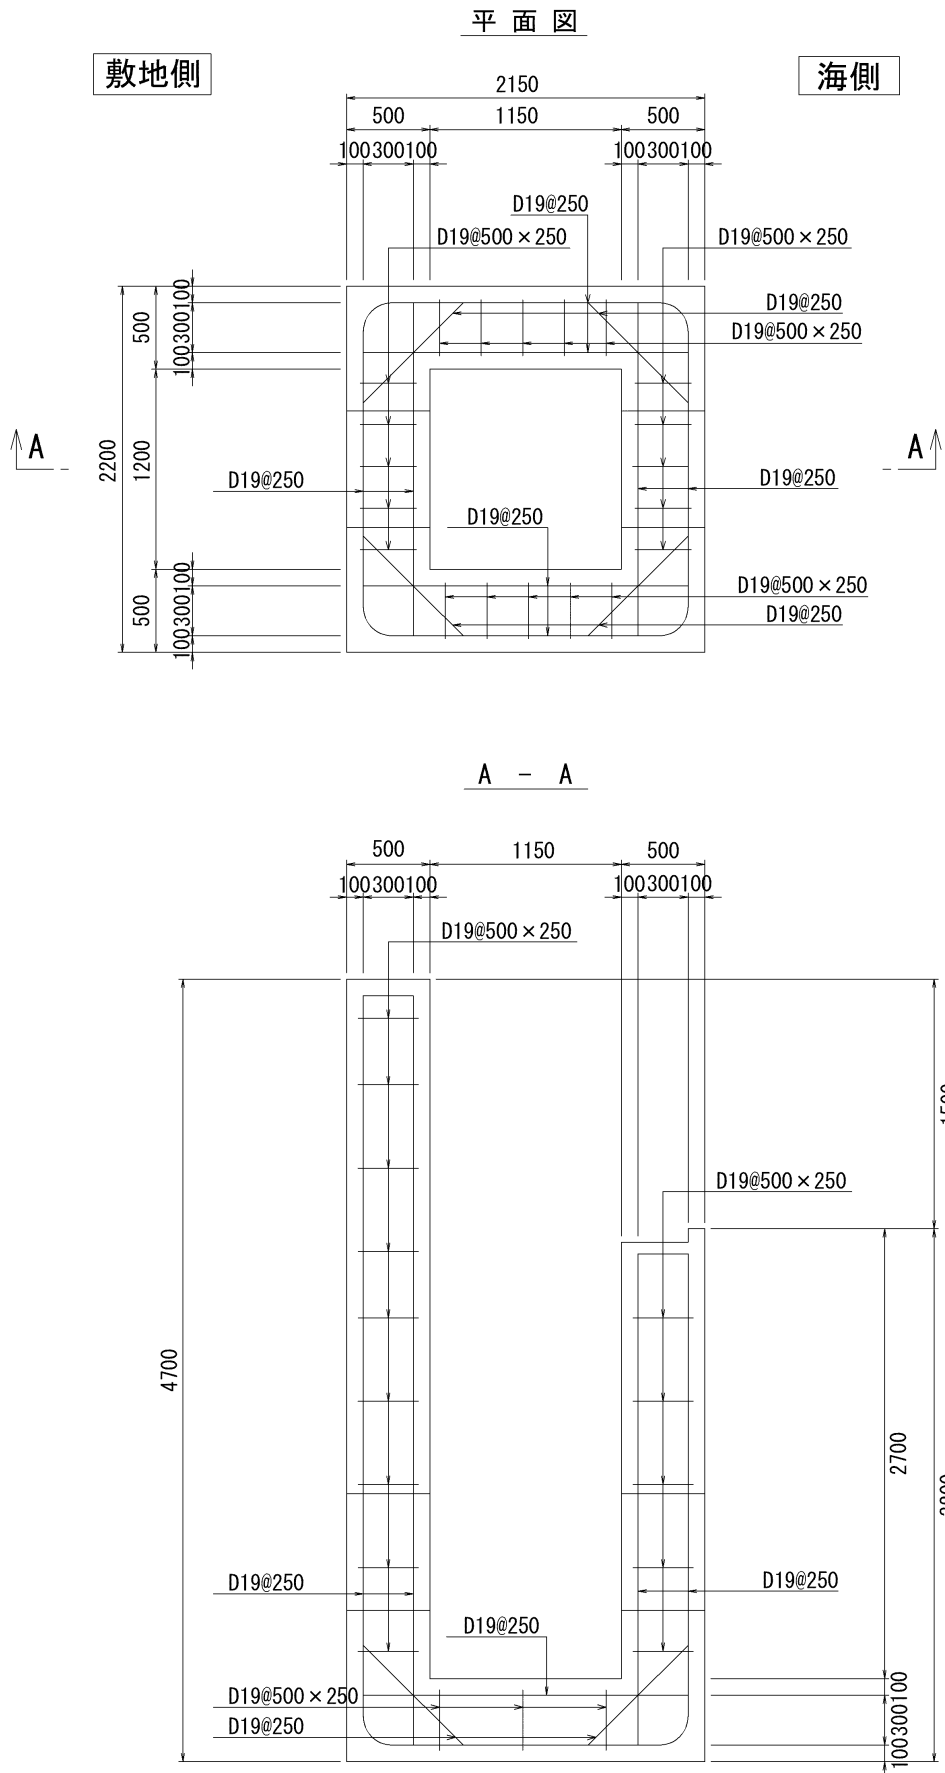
(1) 概略配筋図 (集水枘 (屋外排水路逆止弁⑦)) (単位: mm)
